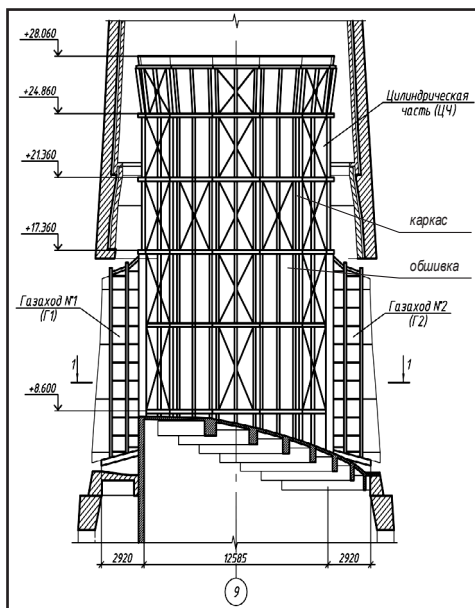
Схема внутреннего газохода железобетонной дымовой трубы
